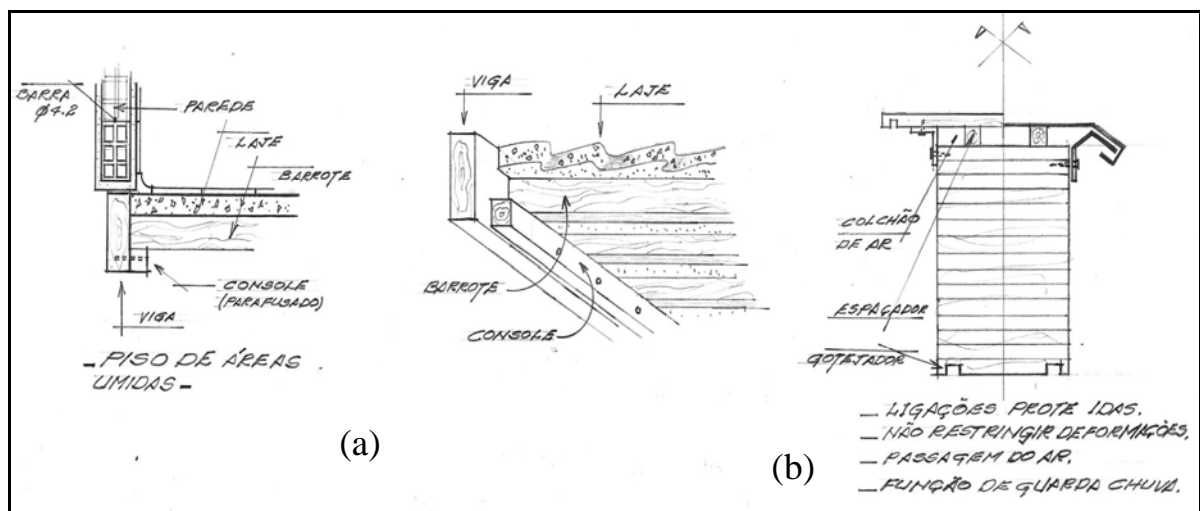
(a) Detalhes para pisos de áreas molhadas e (b) Longarina de ponte de madeira
